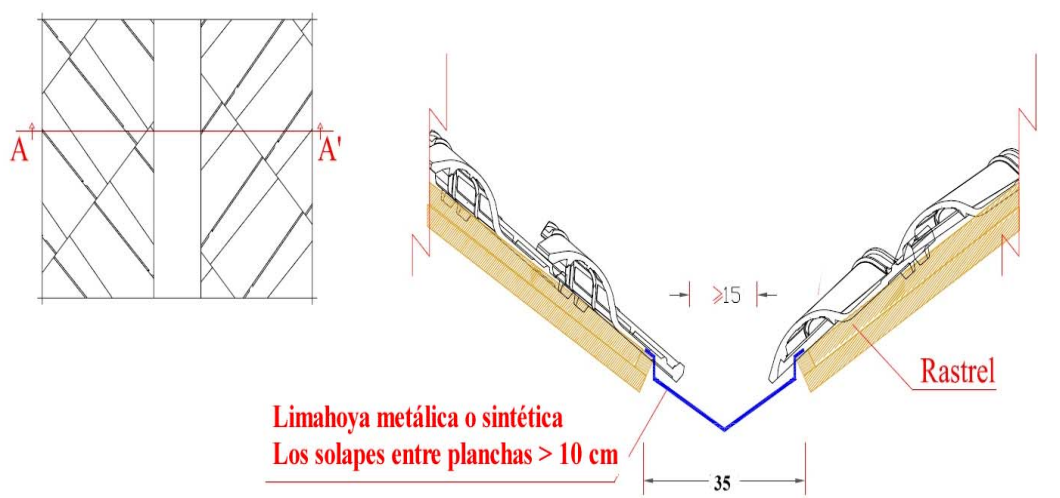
Esquema de ejecución de limahoya (planta y sección)
